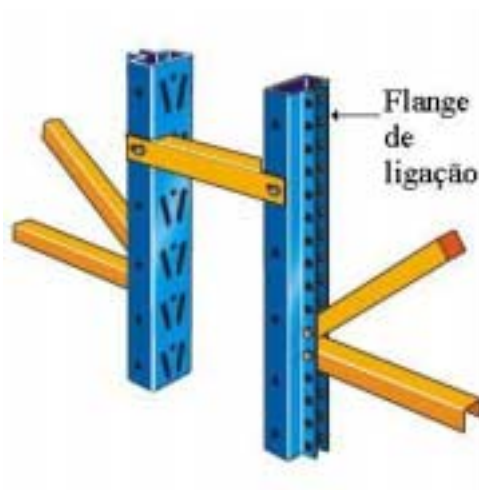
Coluna com seção tipo *rack* ou “garrafa”, com flanges adicionais para conexão dos contraventamentos, (Altamira (2002)).
